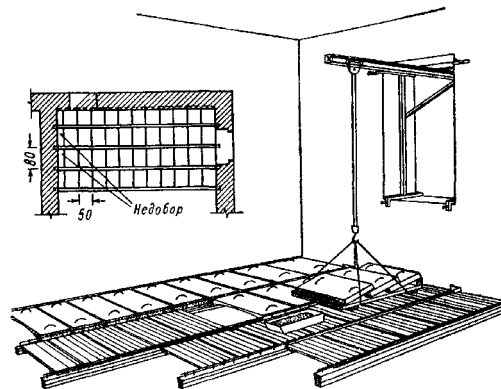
Общая схема организации работ по устройству сборно-монолитного перекрытия
